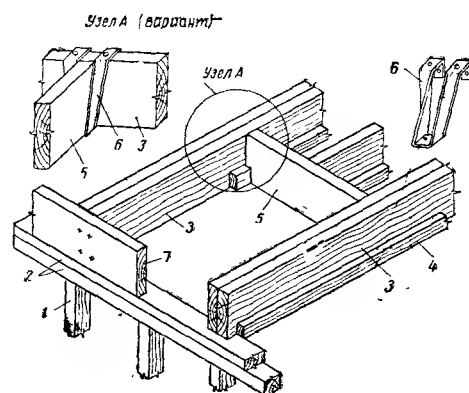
Конструкция чердачного перекрытия каркасного дома
